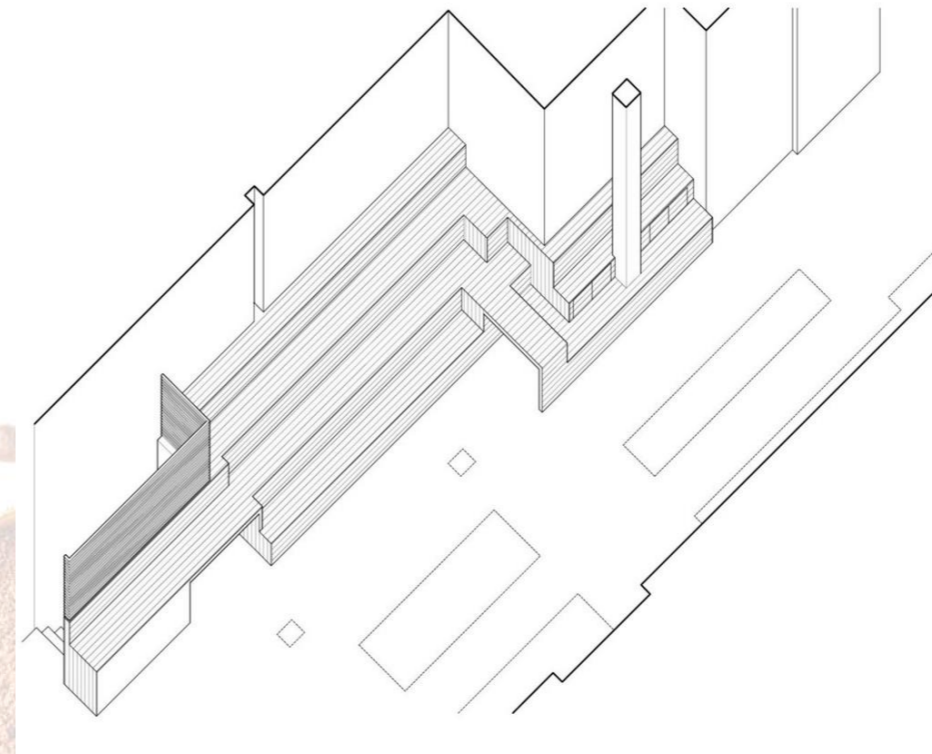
Detalle de tribuna, fuente: Archdaily.com, 2013
